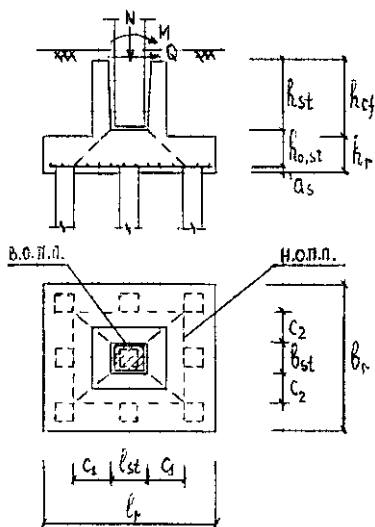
Схема образования пирамиды продавливания под сборной железобетонной колонной прямоугольного сечения
